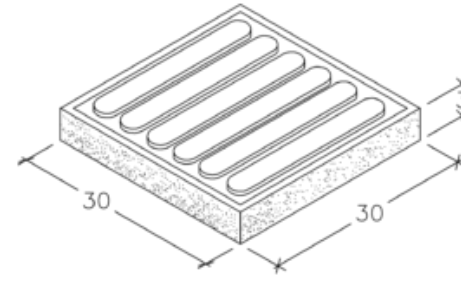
1 Baldosa hidráulica de hormigón de 6 barras.
